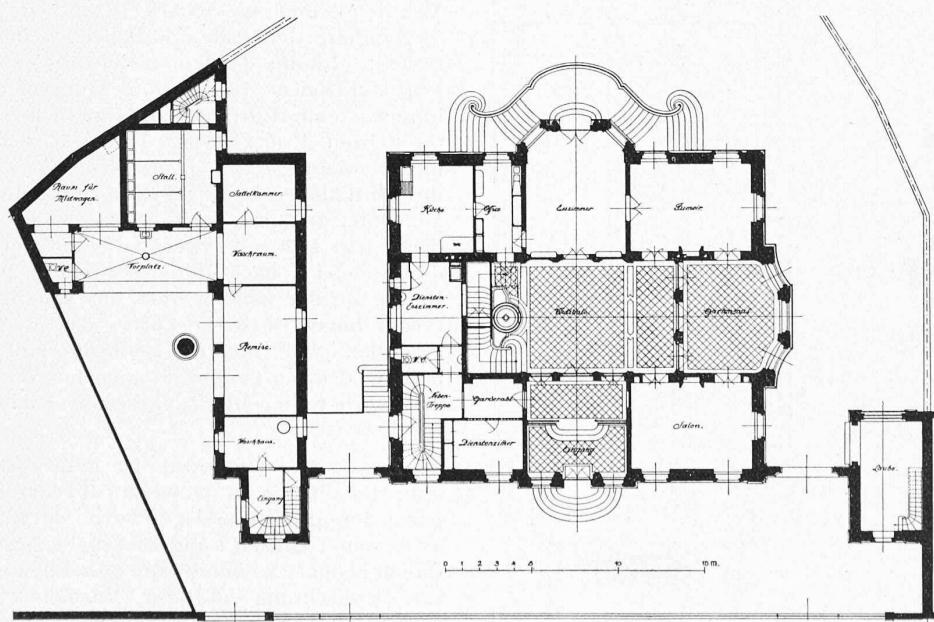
Grundriss vom Erdgeschoss des Wohnhauses und des Stallgebäudes. — Maßstab 1:400.
